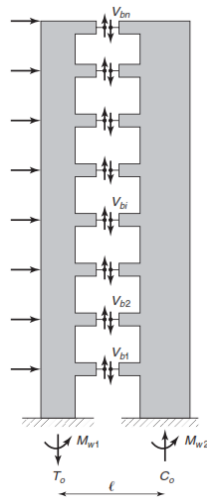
Equilibrio de fuerzas en la estructura con vigas de acople (Fuente: Wight & McGregor)
